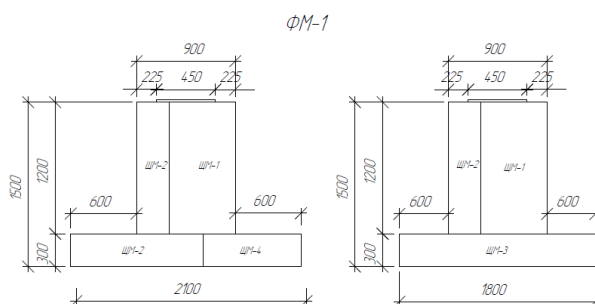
Расположение щитов опалубки для фундамента ФМ-1
